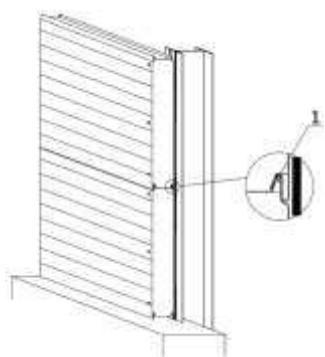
Установка уплотнителя. 1 – трубчатый уплотнитель (герметик)
